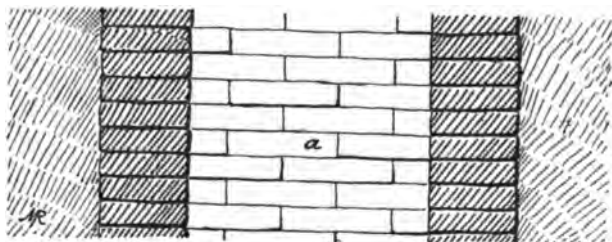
Coupe verticale d'un puits à section rectangulaire (Khorsabad).
